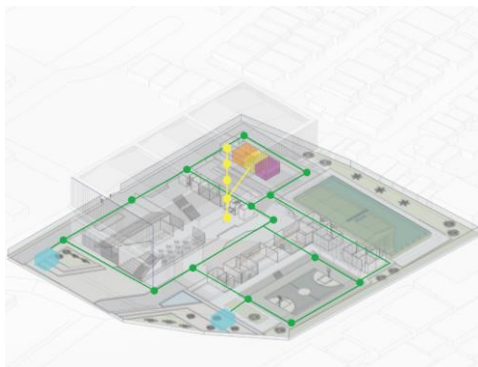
4. Gambar denah bak kontrol dan saluran air hujan.
